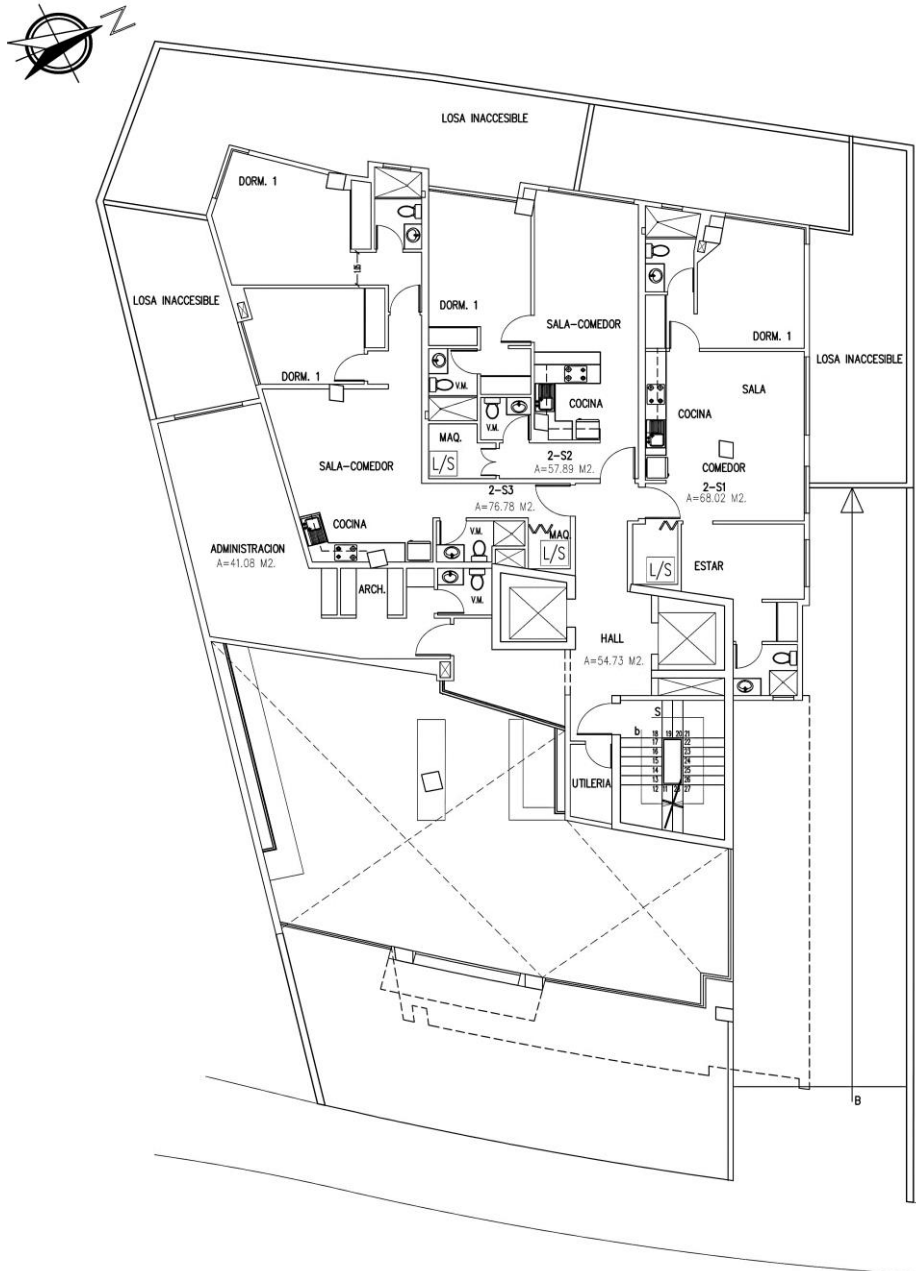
Planos Arquitectónicos Edificio Boheme - Mezzanine
